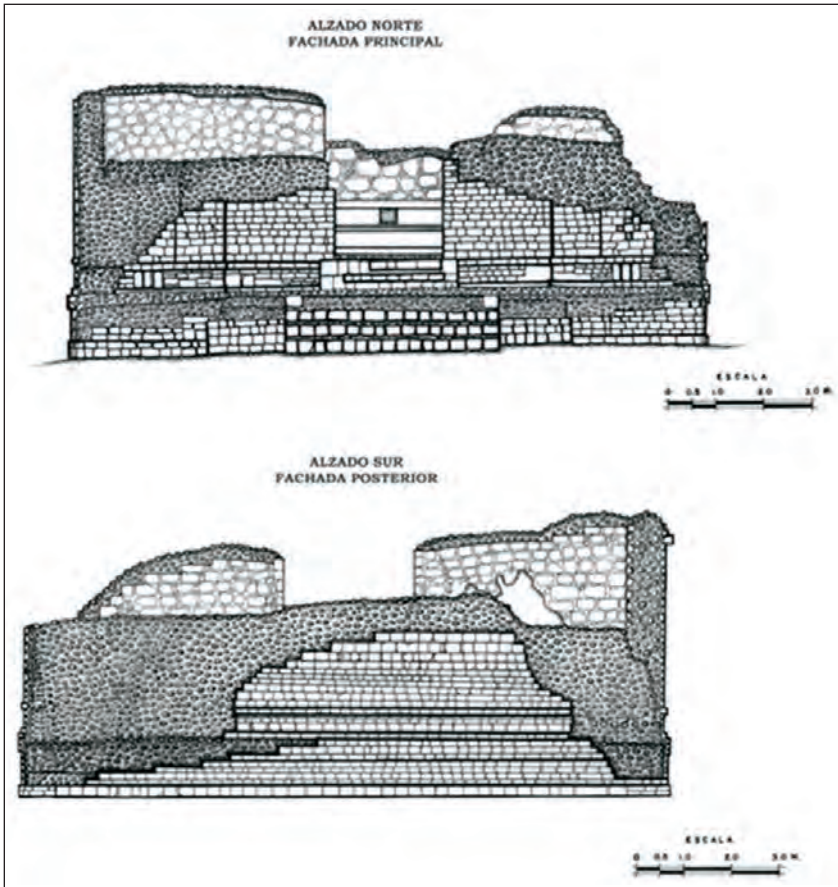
Alzado de las fachadas principal y posterior de la estructura VII.
